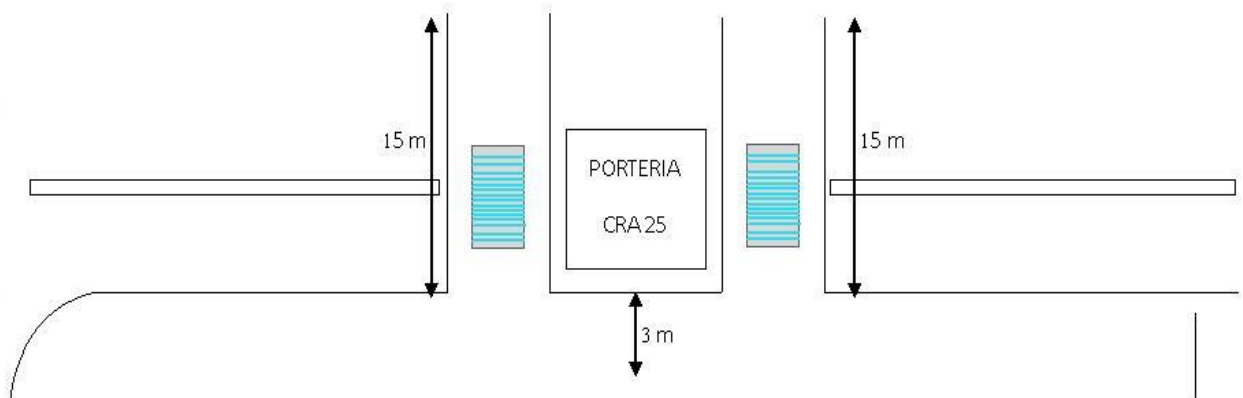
Entrada carrera 25 con el dispositivo de Electro KineticRoad Ramp Instalado.
